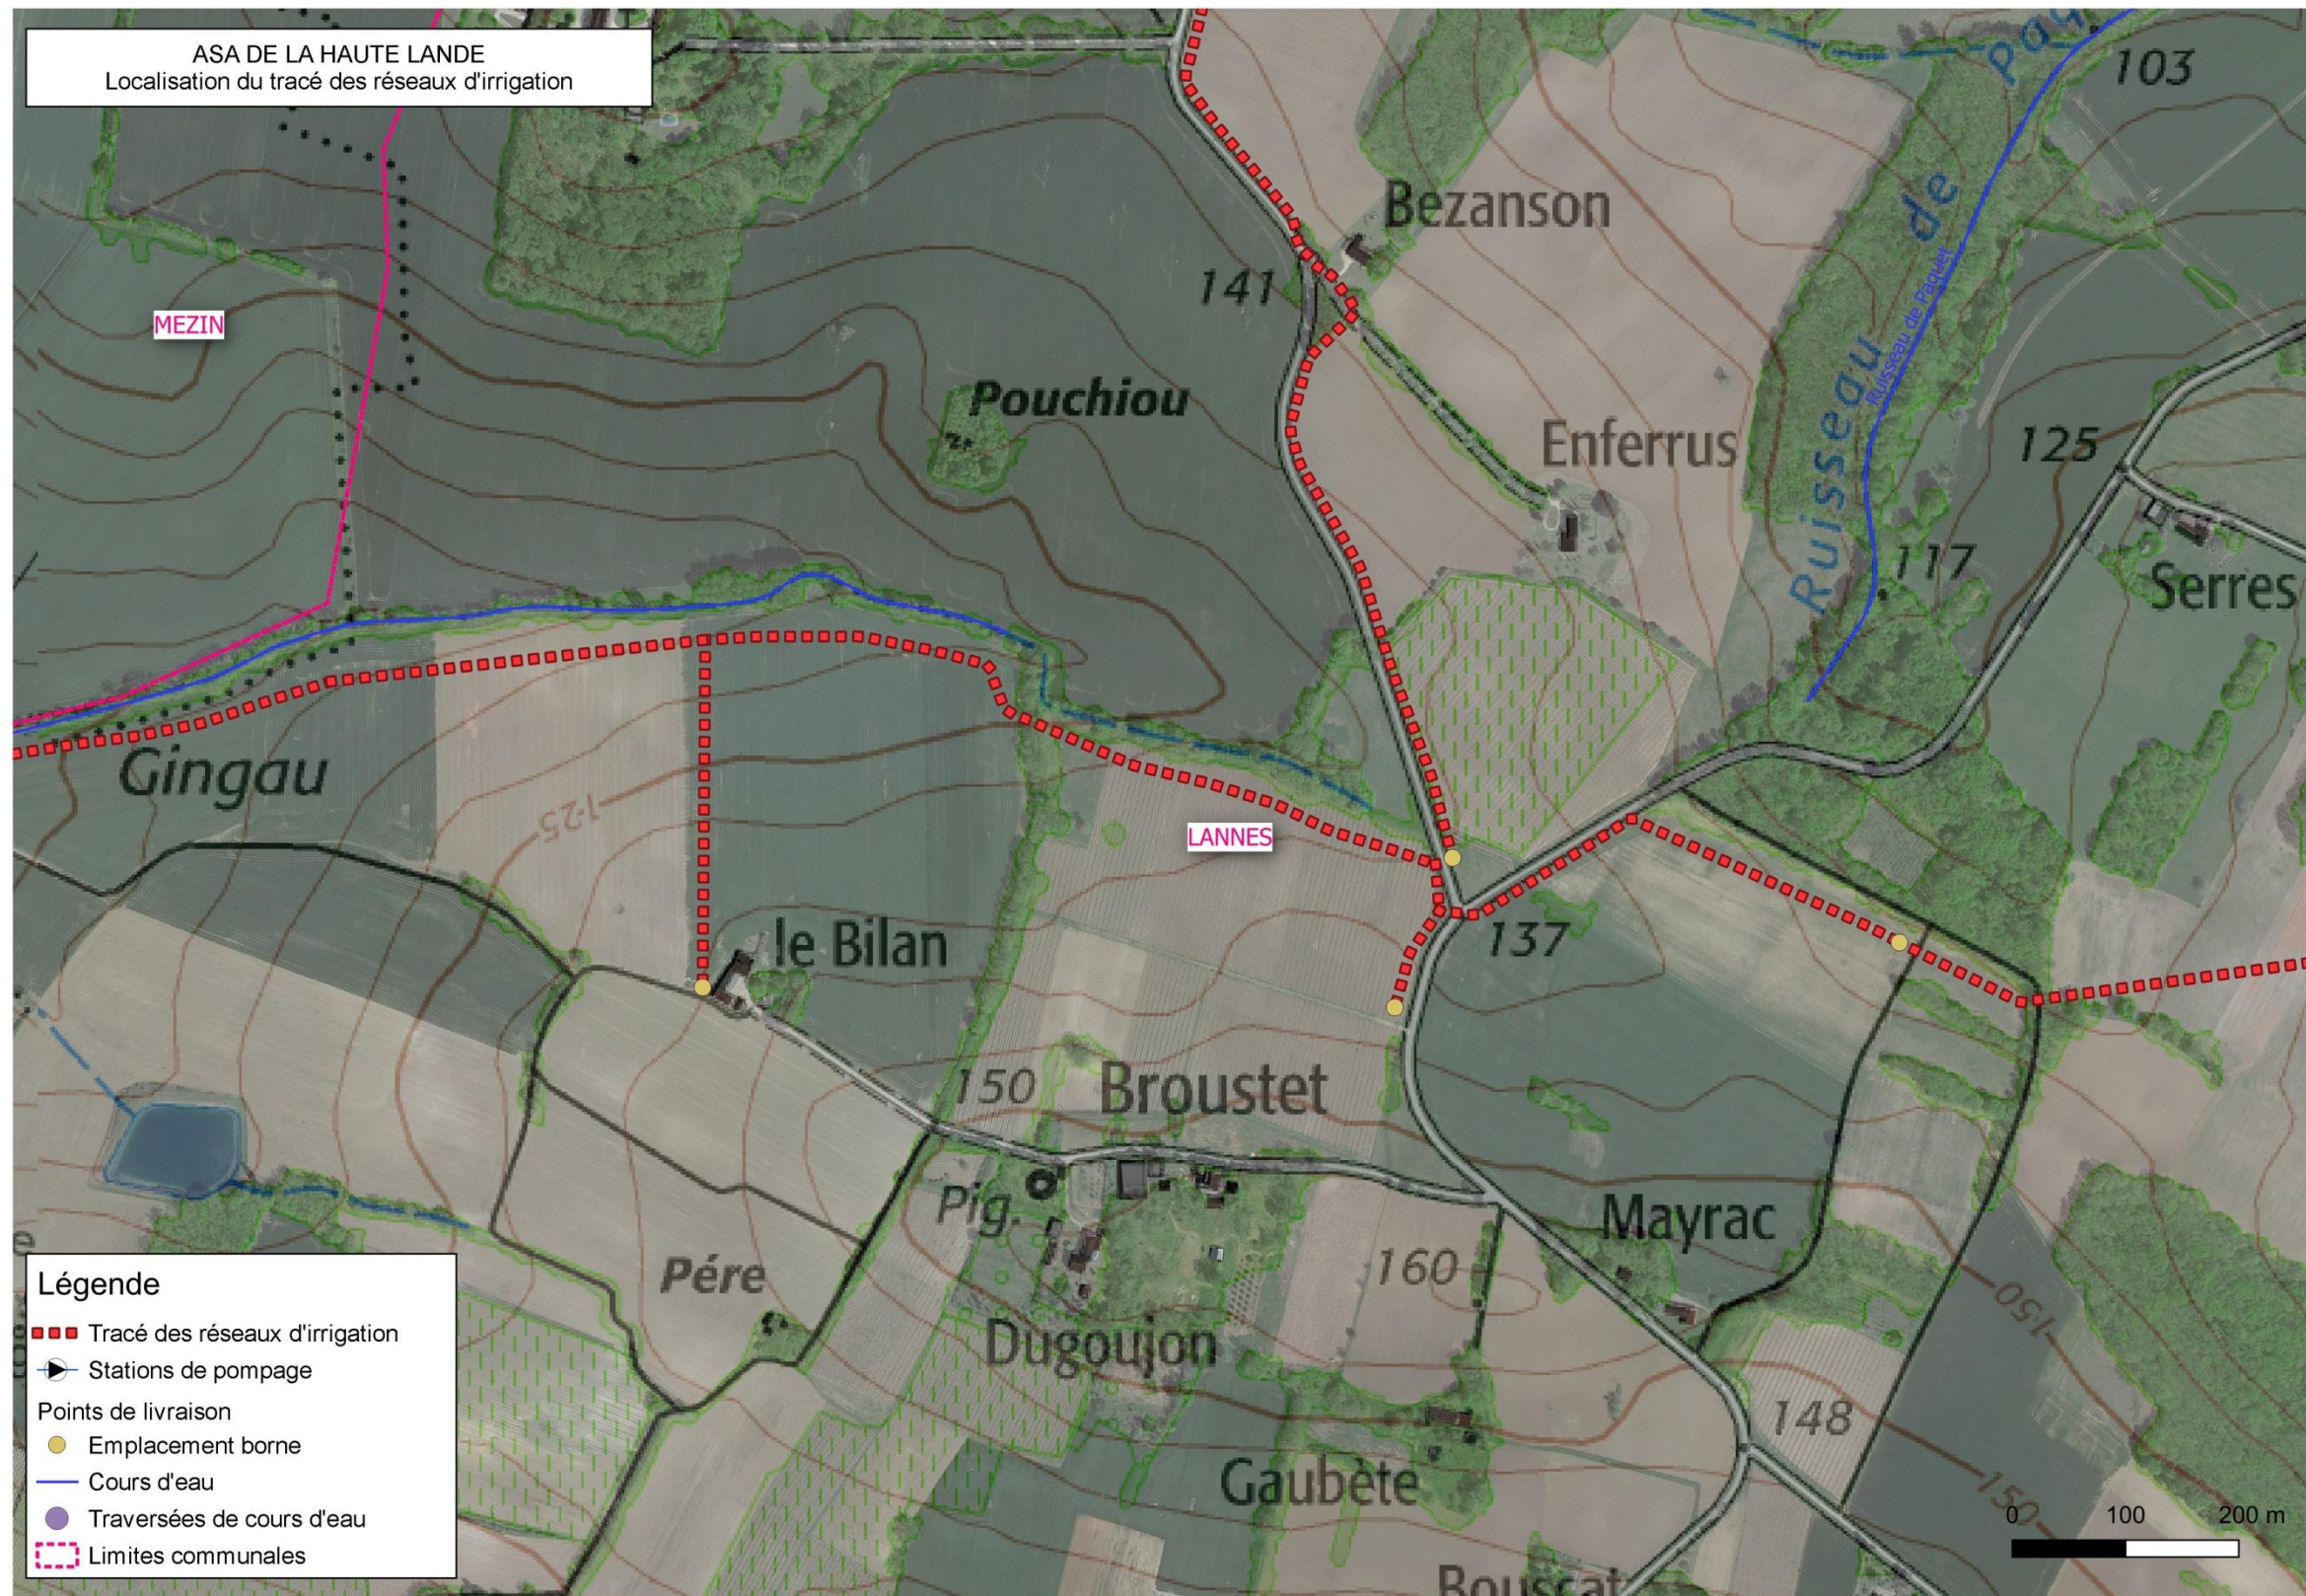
Plan des abords au 1/5000 - planche 2/8
